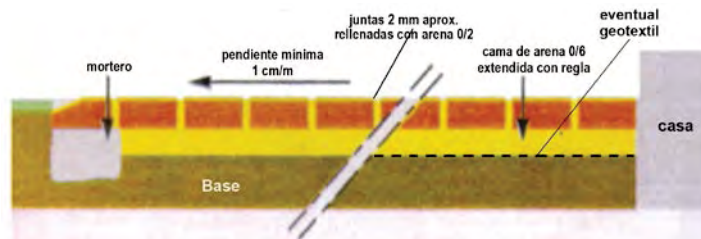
PAVIMENTO FLEXIBLE DE ADOQUINES DE BARRO asentado sobre cama de arena
